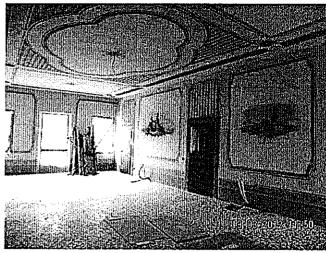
Stanza 1.5 (sala)- Vista interna.parete lato corte.
